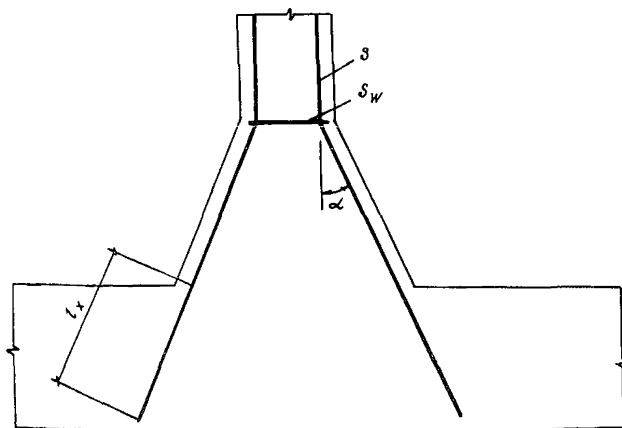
Схема для расчета промежуточного узла безраскосной фермы
